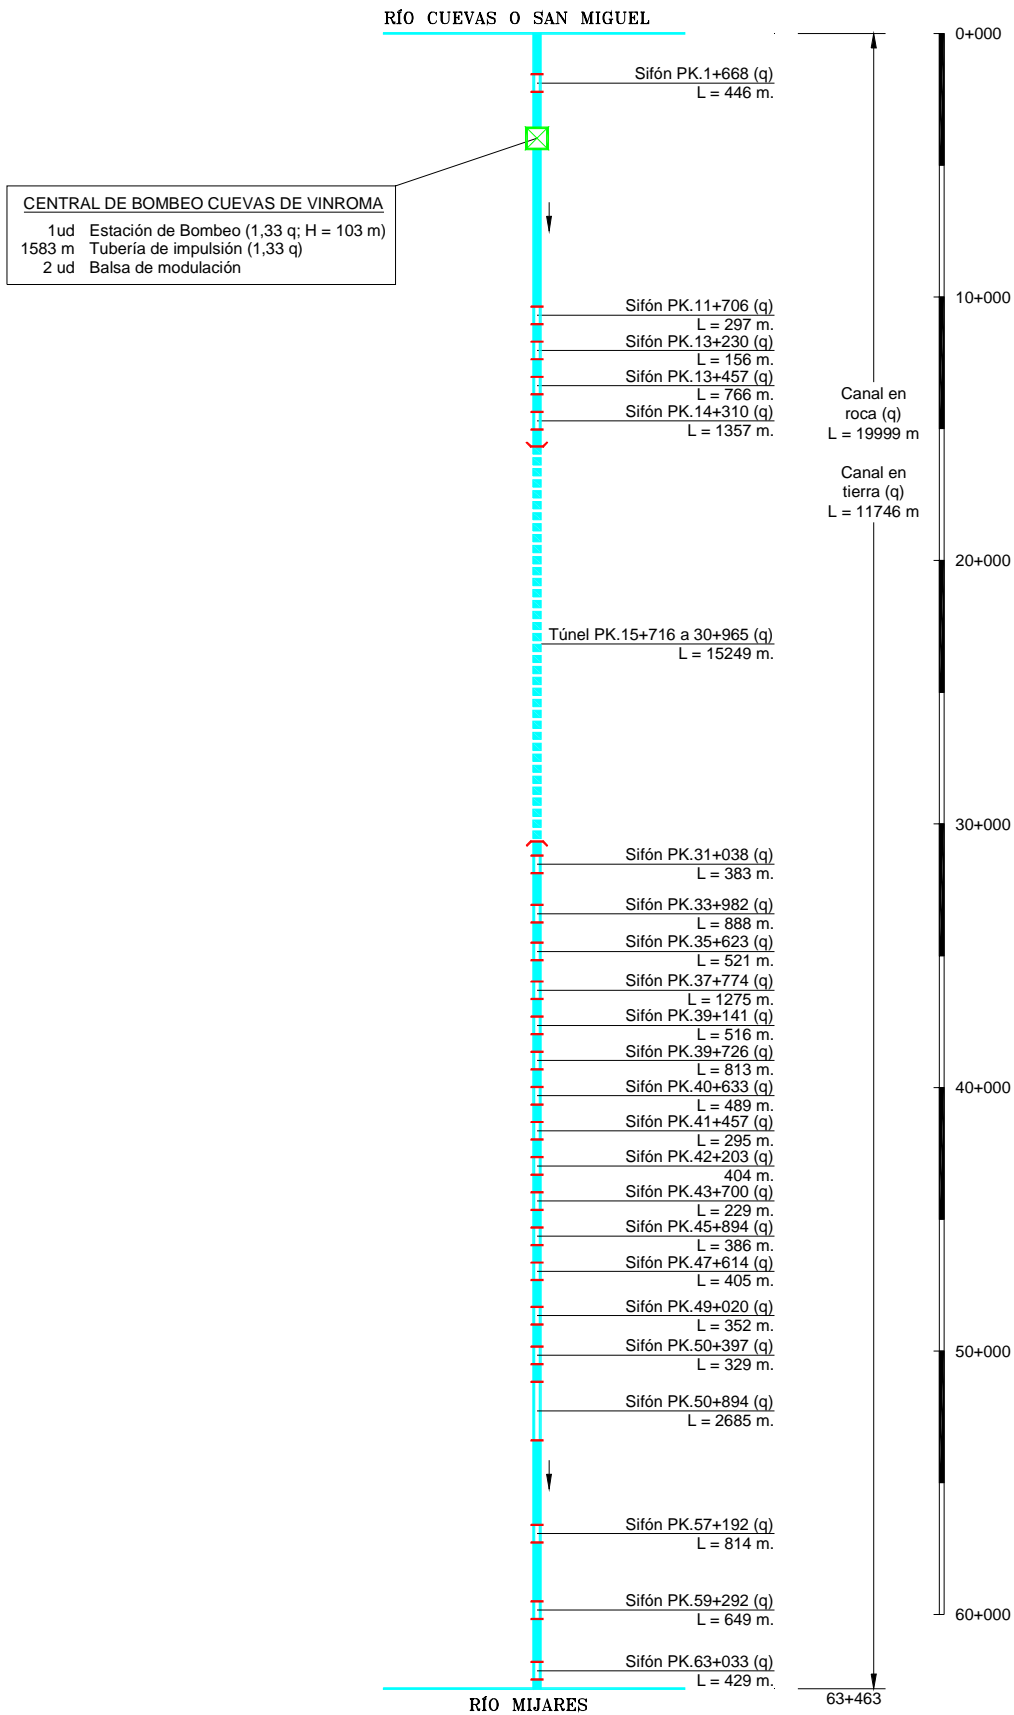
Conducción Castellón Norte - Mijares. Esquema en planta
